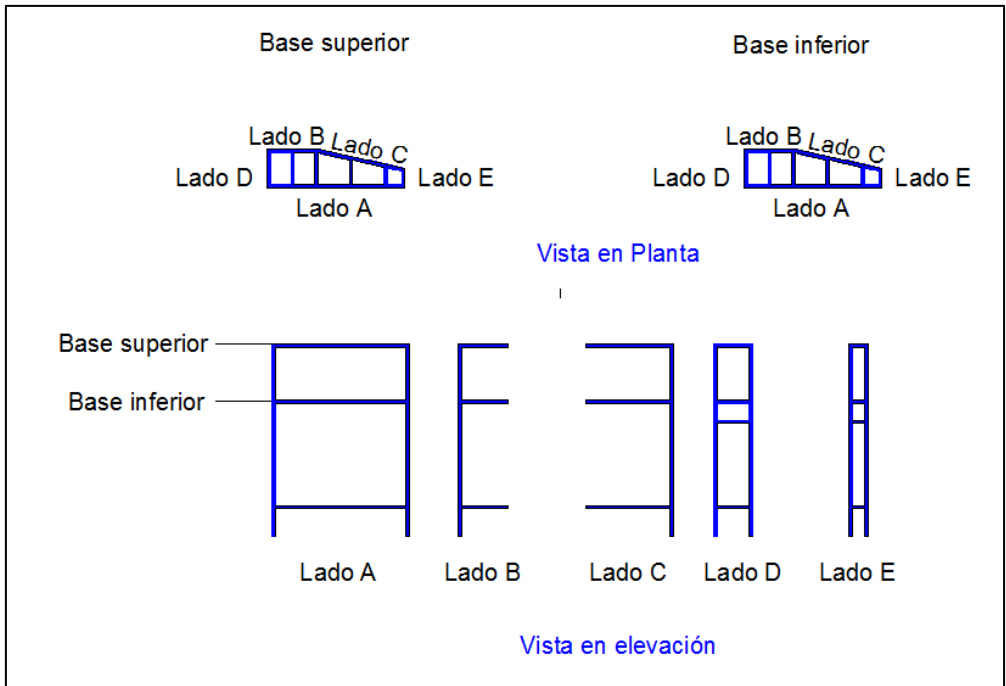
Vista en elevación de estructura de soporte de tanque de circulación
